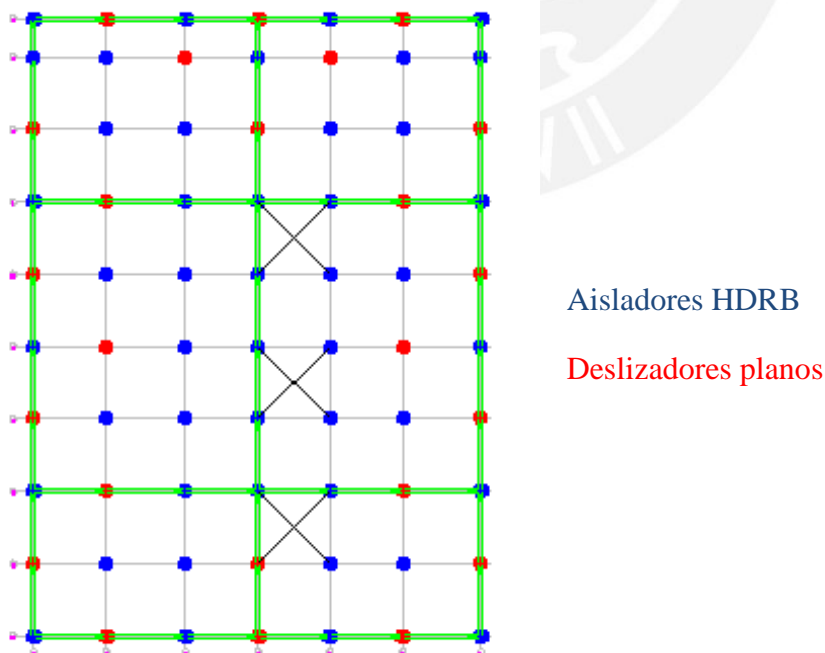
Ubicación de los aisladores HDRB y de los deslizadores planos.
